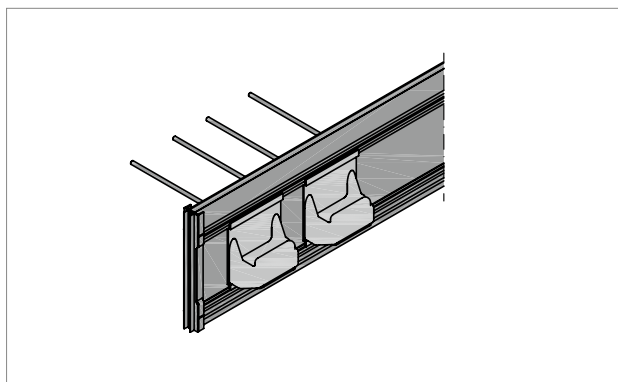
Schöck Tronsole® Typ T : Detail Tragkonsole positive Fertigung
